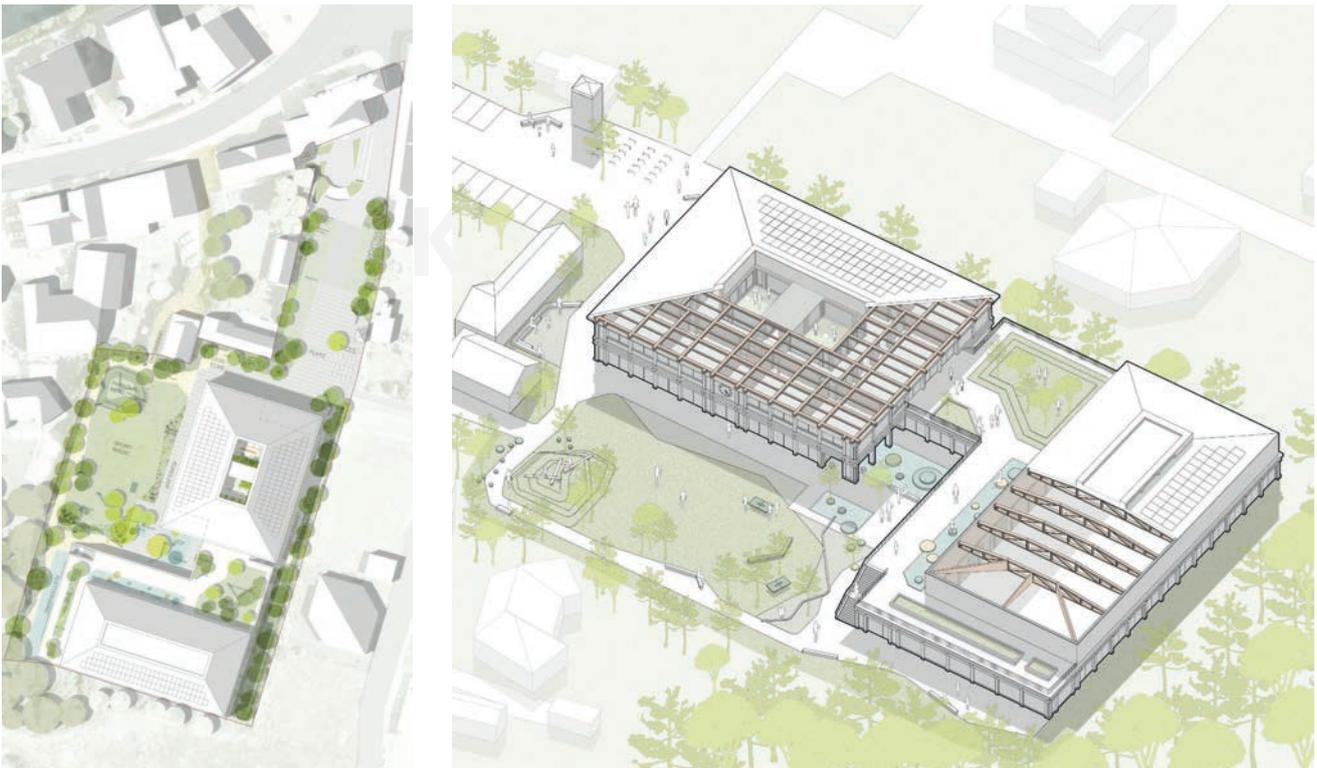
Lageplan (links), Wimmelbild (rechts)
